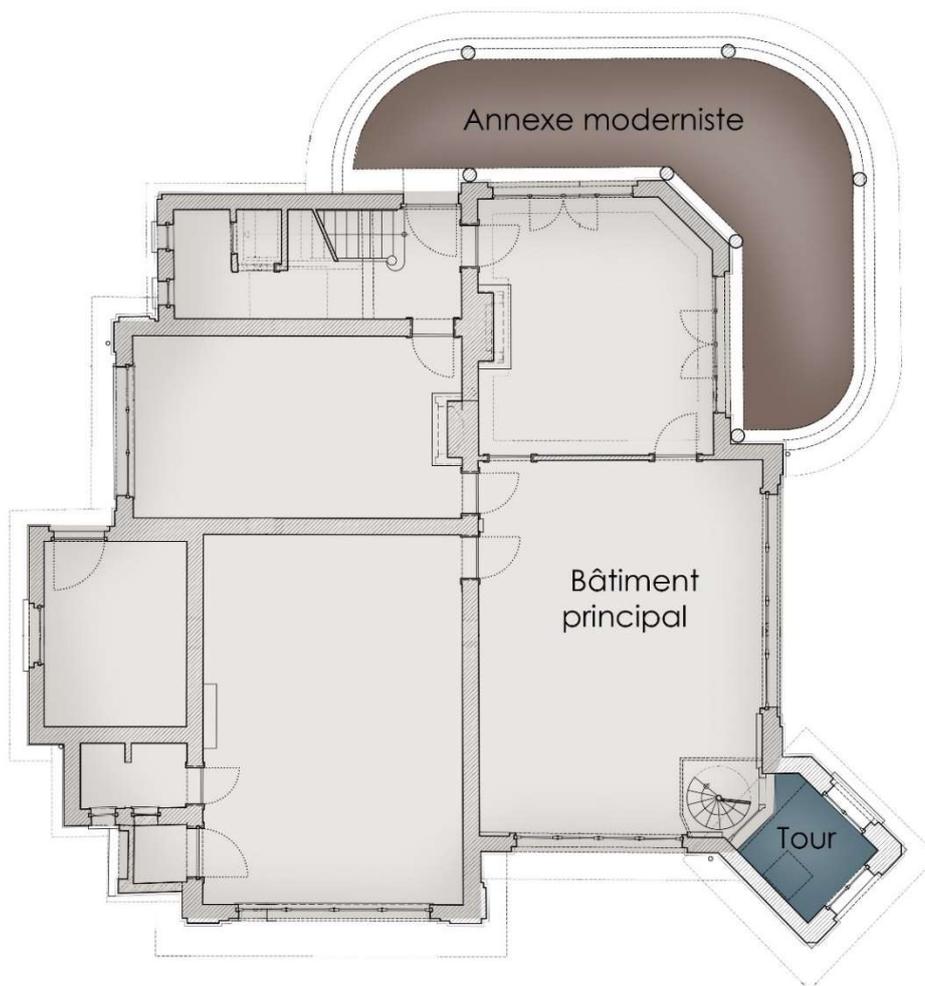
Bâtiment de pesage - plan RDC (Origin, 2014)
